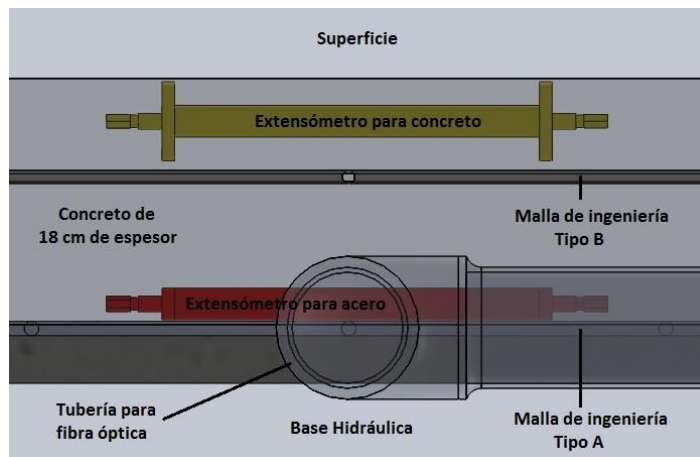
Distribución de extensómetros en la losa de concreto PCERC.
